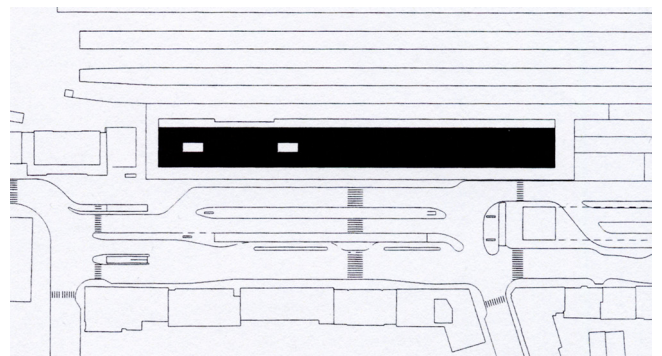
Lageplan Hauptbahnhof Innsbruck
